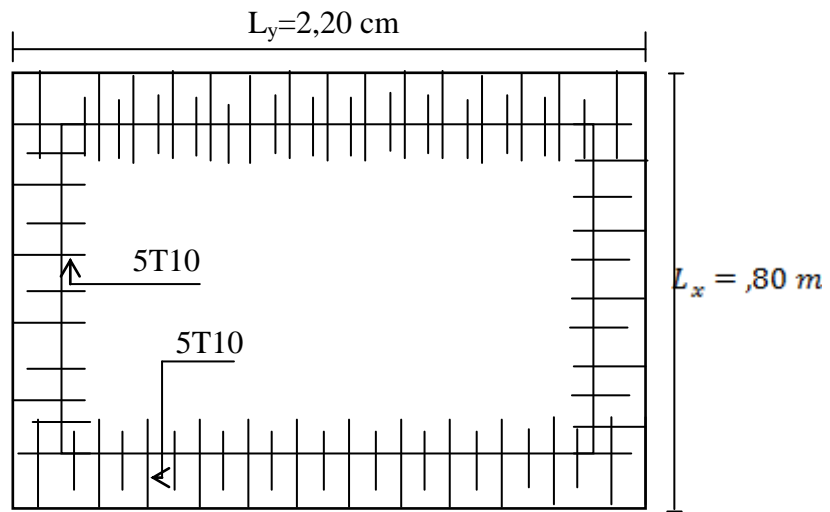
Ferrailage supérieur de la dalle de l'ascenseur
